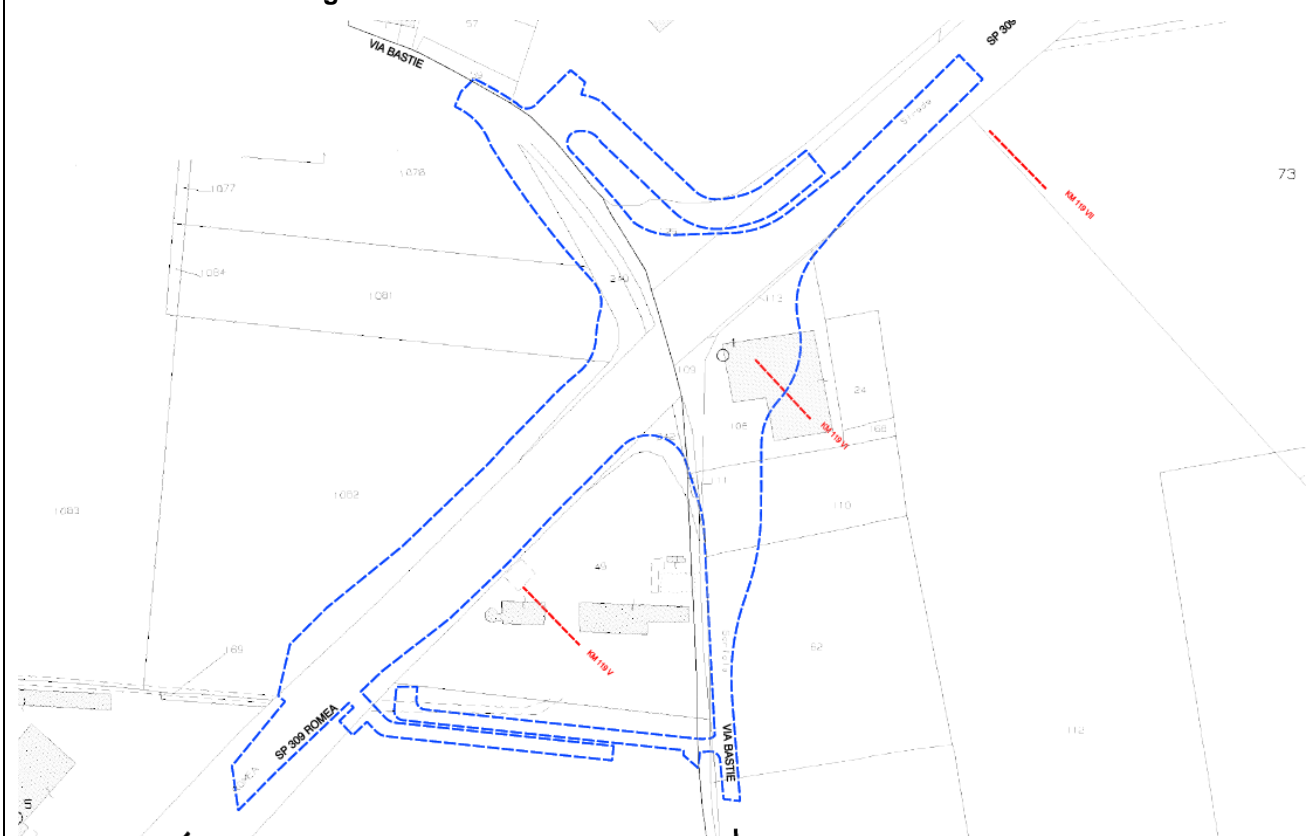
Individuazione dell'area di intervento su planimetria catastale.
